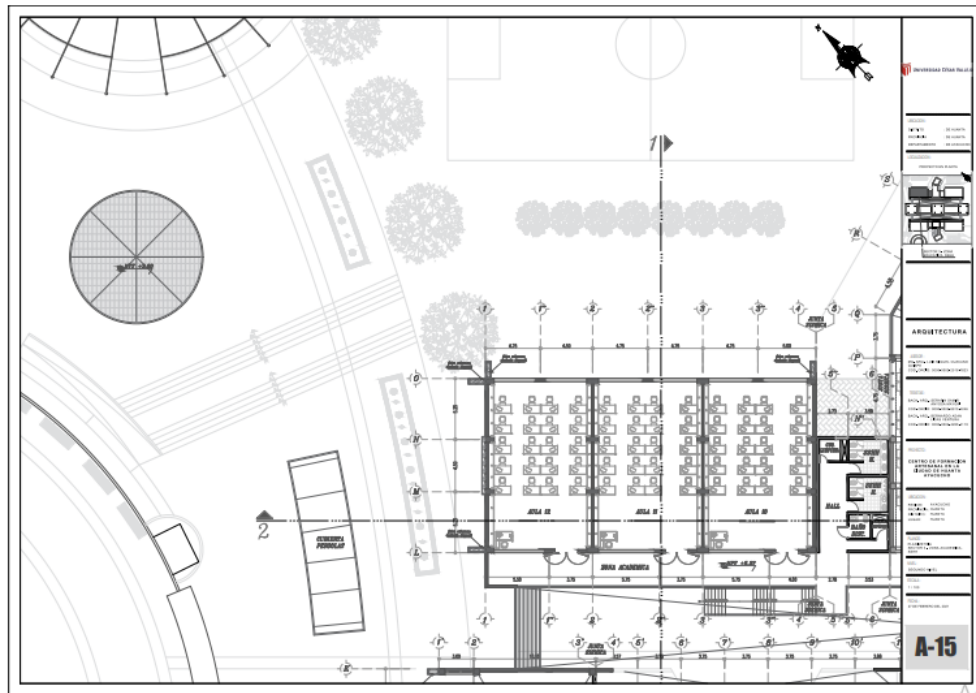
Planimetría del sector 3 ubicado en el piso 2. Escala 1/100.
